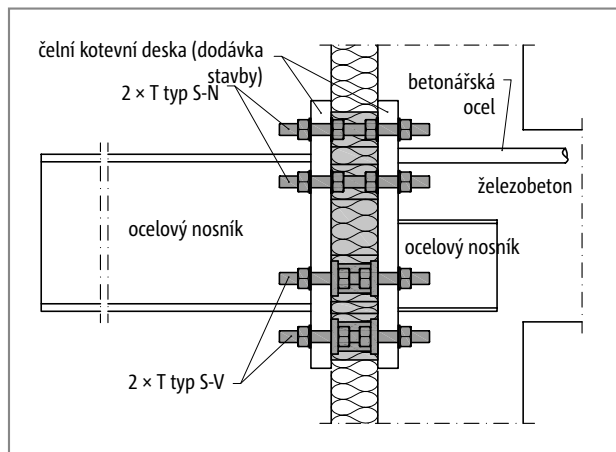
Schöck Isokorb® T typ S-N a T typ S-V: Volně vyložená ocelová konstrukce
